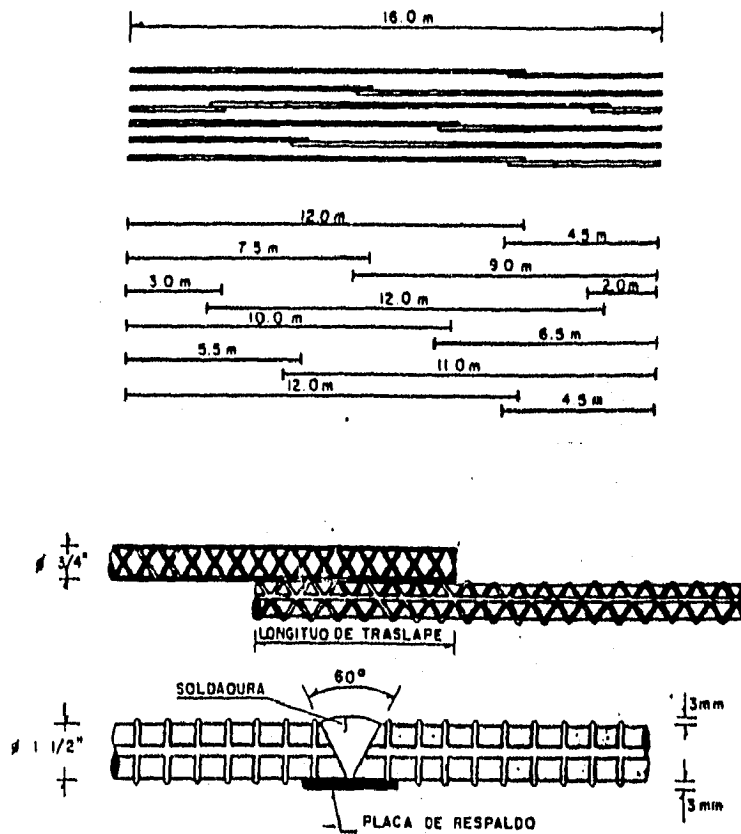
TRASLAPES Y SODADURA DEL ARMADO DE REFUERZO (REF.7).
